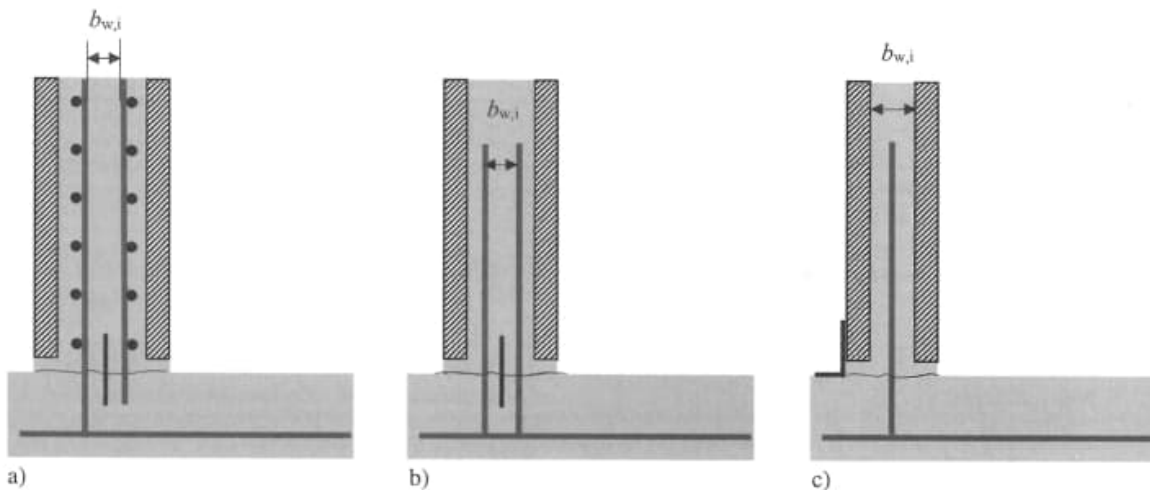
Beispiele für lichte Innenmaße $b_{w,i}$ bei Elementwänden; a) lichter Abstand zwischen 2. Lage Bewehrung wegen Betonierbarkeit bei innenliegender Fugenabdichtung, b) lichter Abstand zwischen vertikaler Anschlussbewehrung wegen Betonierbarkeit bei innenliegender Fugenabdichtung, c) lichter Abstand zwischen Elementwänden bei nur vertikaler Anschlussbewehrung und außenliegender Fugenabdichtung
